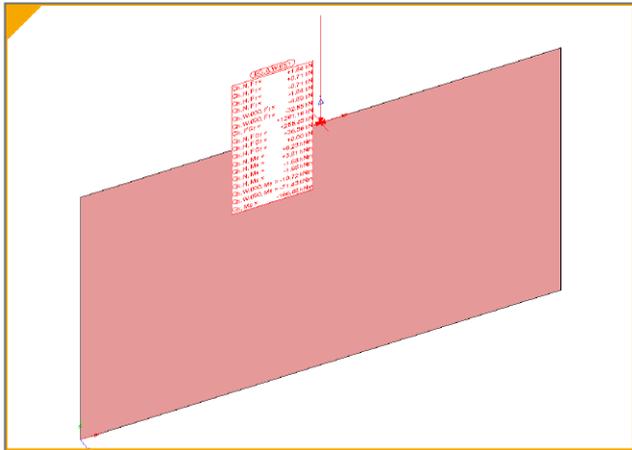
Berechnungsmodell für Mauerwerkswand mit Aussteifungslasten und vertikalen Lasten
